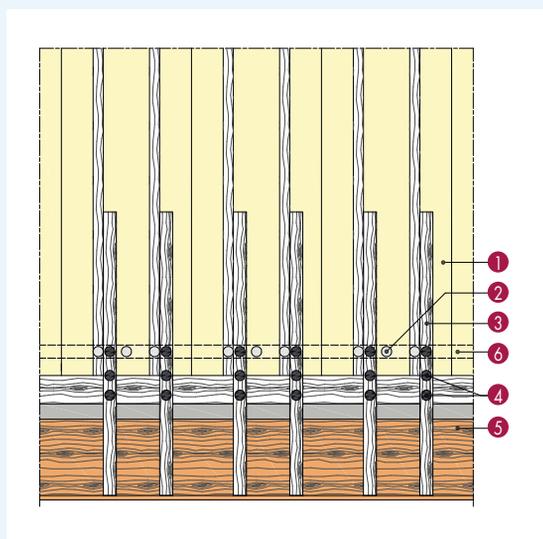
Égout en débord avec faux chevron : vue en plan
